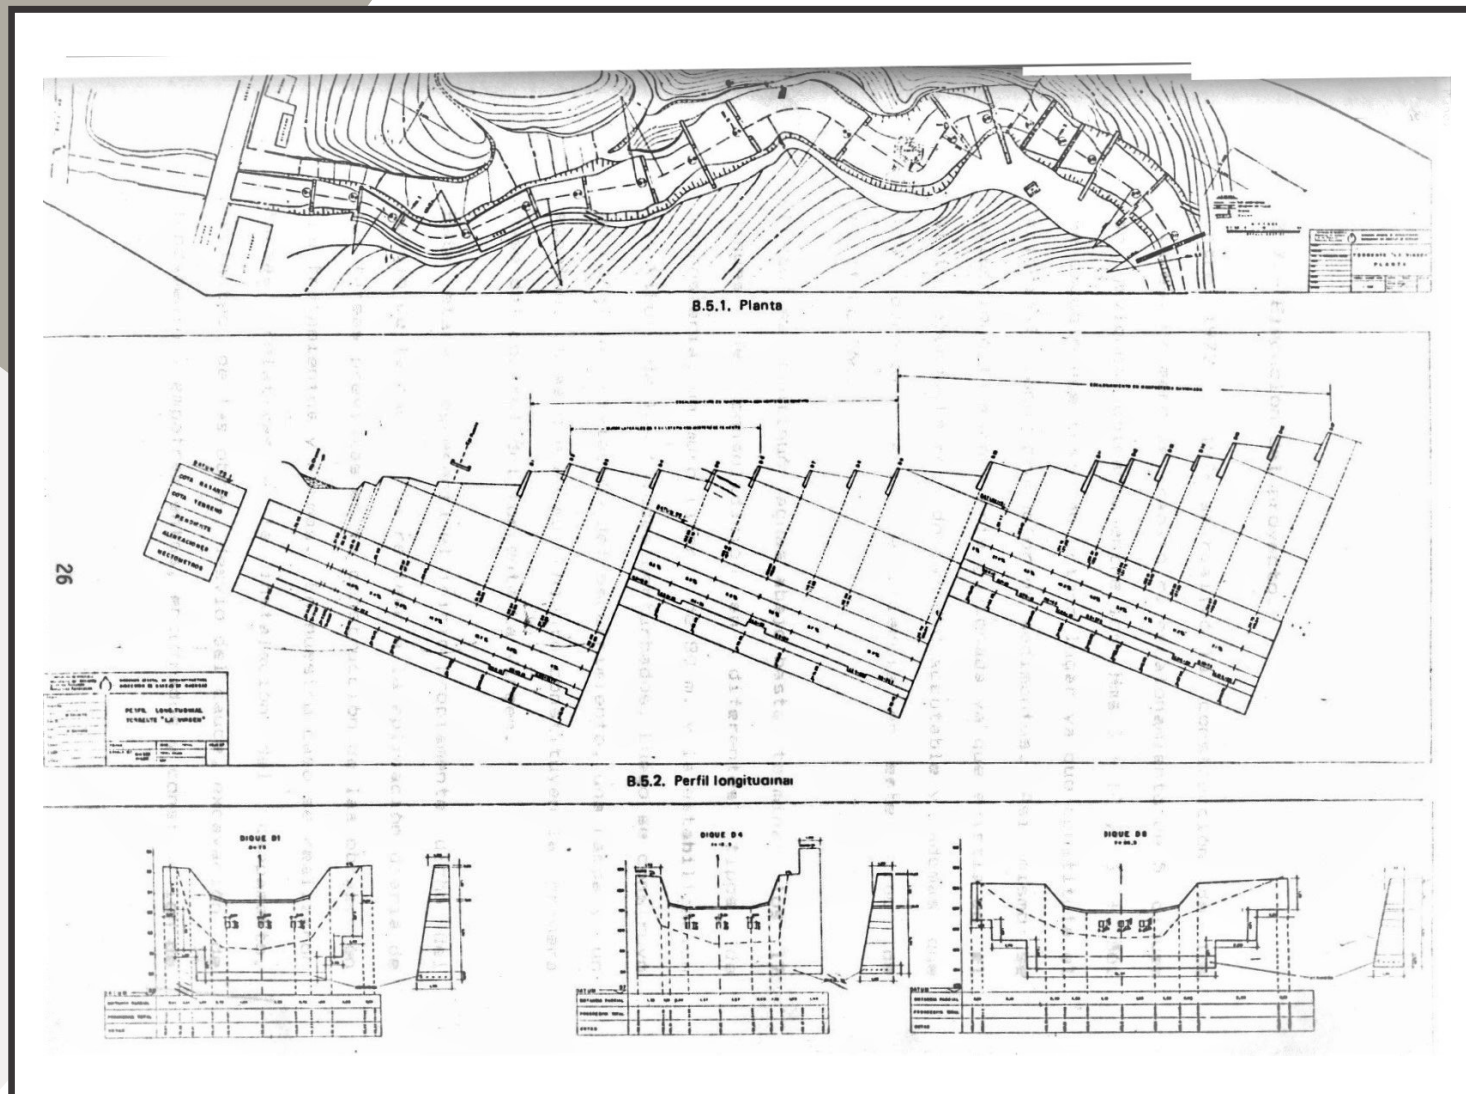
Planta, perfil longitudinal y perfiles transversales con ubicación de las obras en el tramo crítico del torrente La Virgen.
